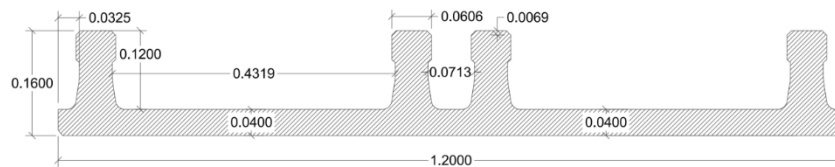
Secção transversal cotada do painel de laje Minos considerado na análise
